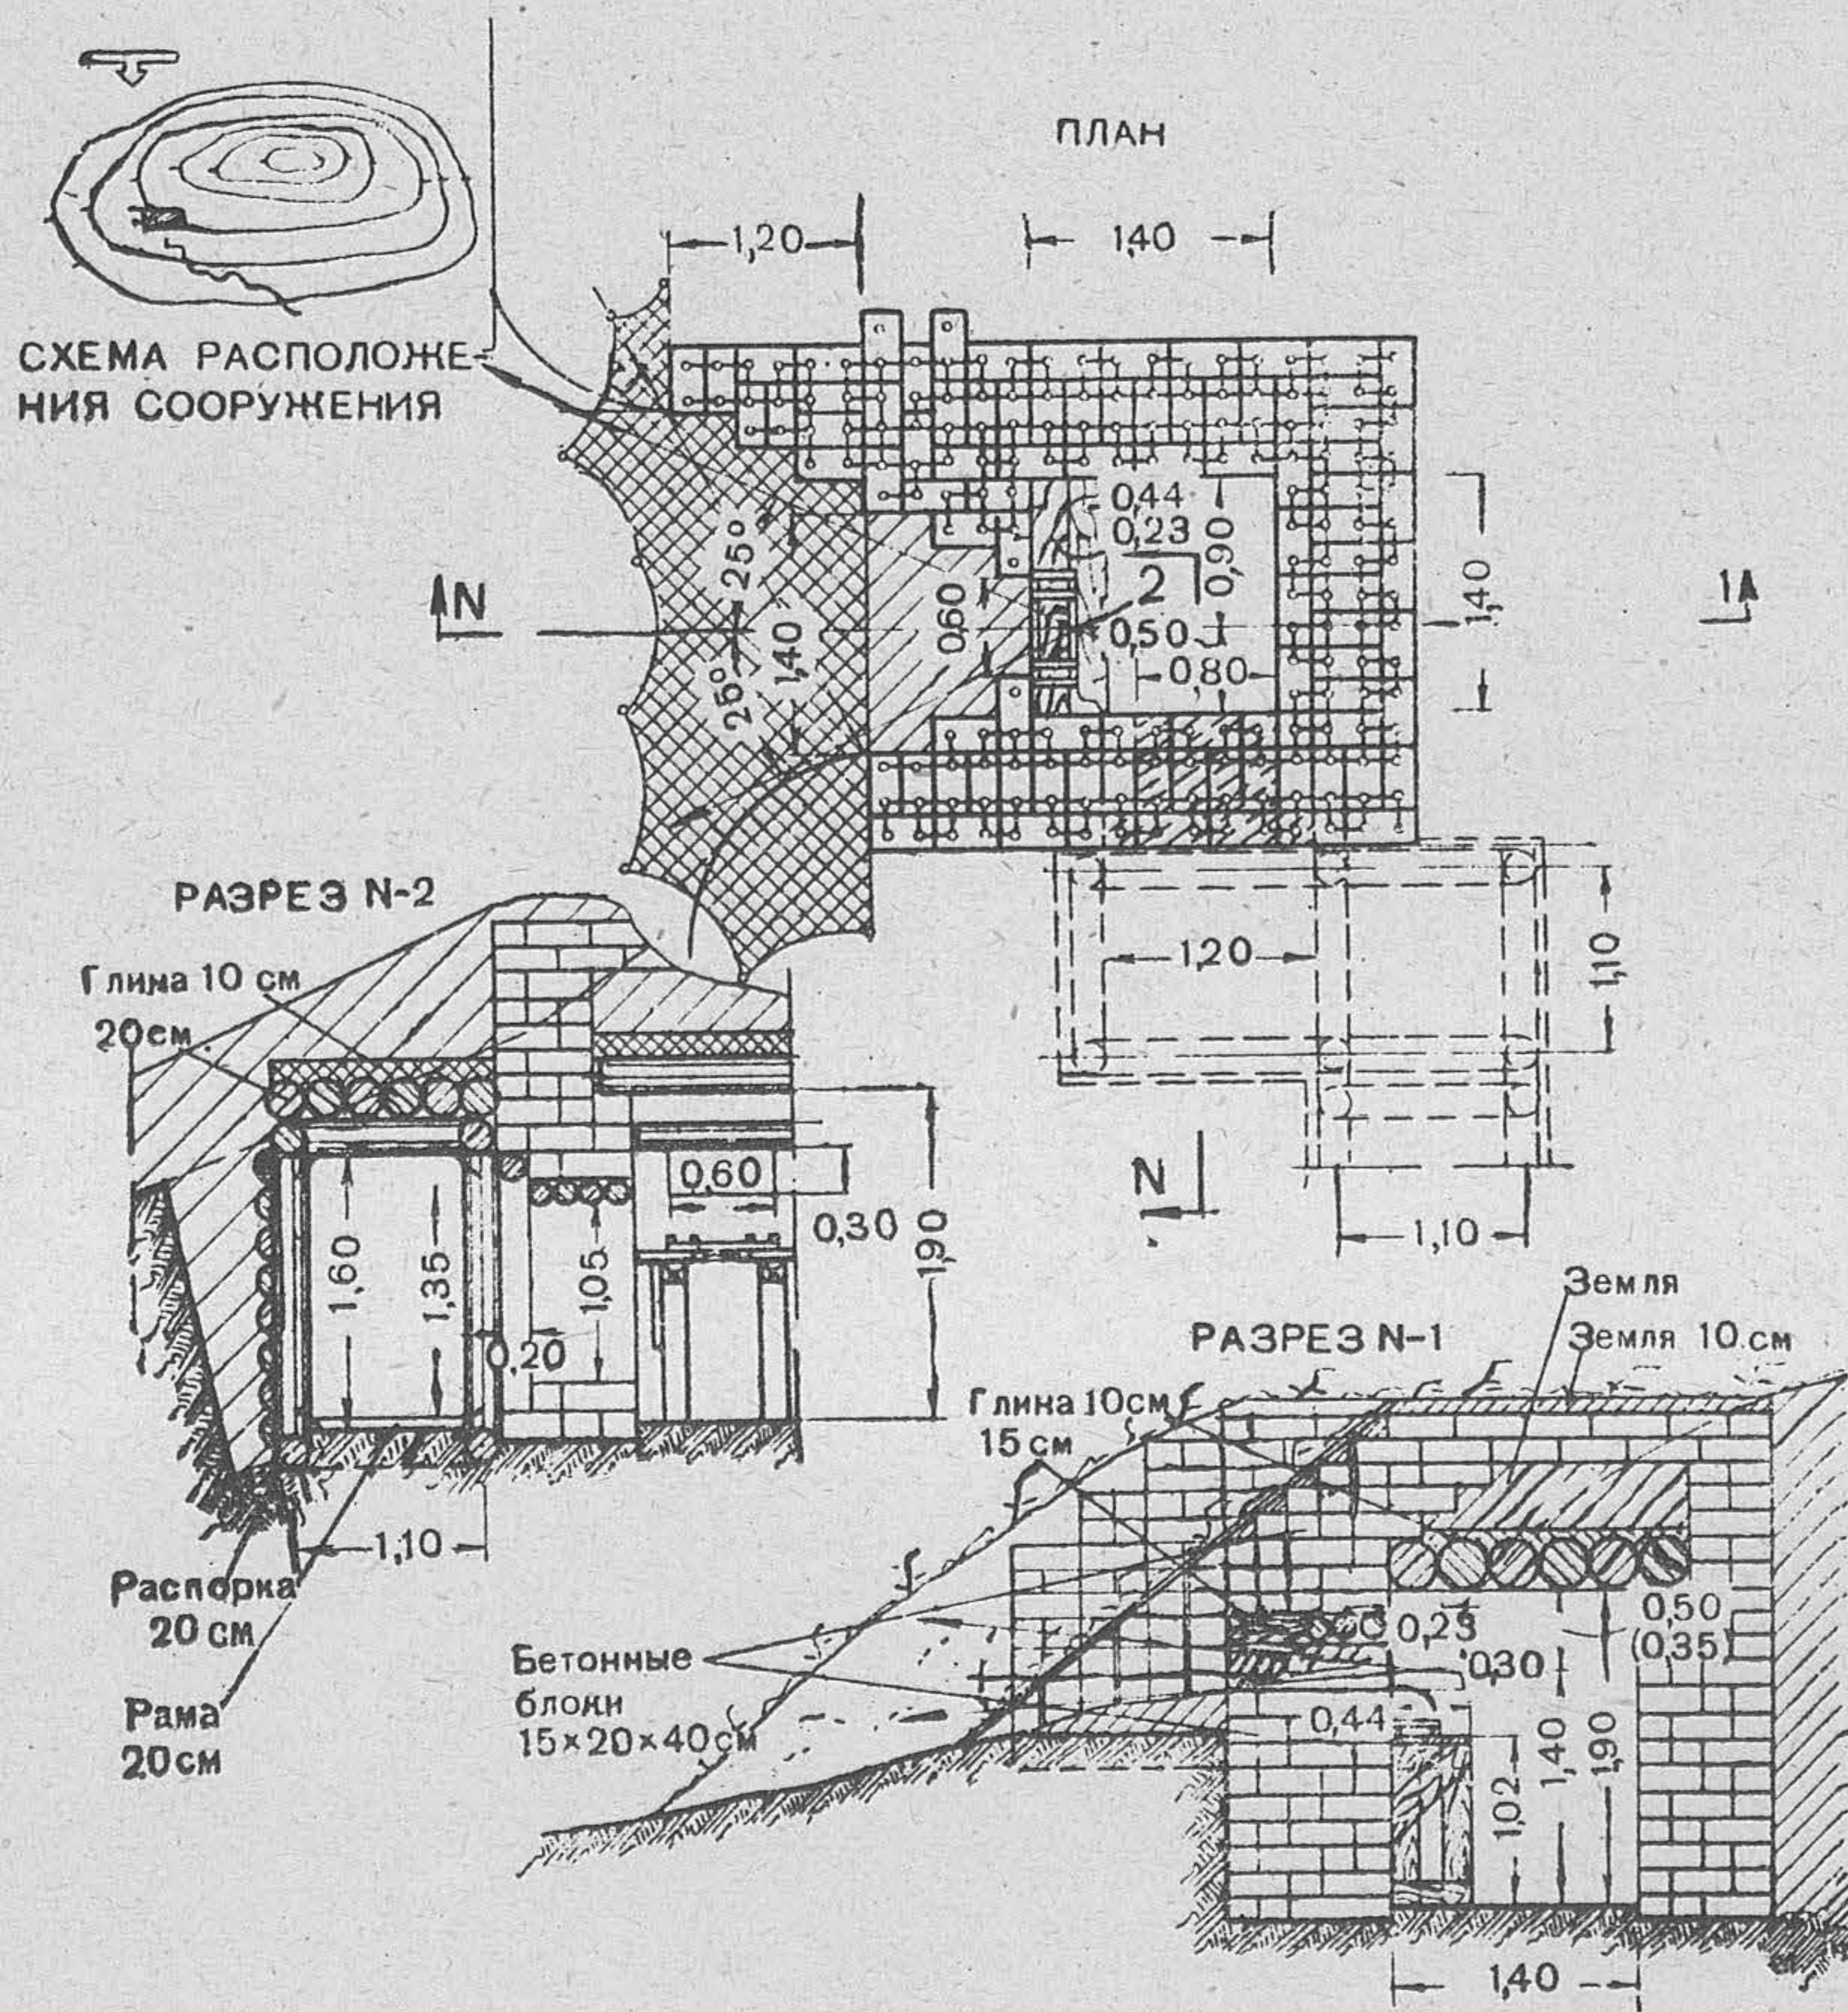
Сборный железобетонный пулемётный полукапонир усиленного типа
